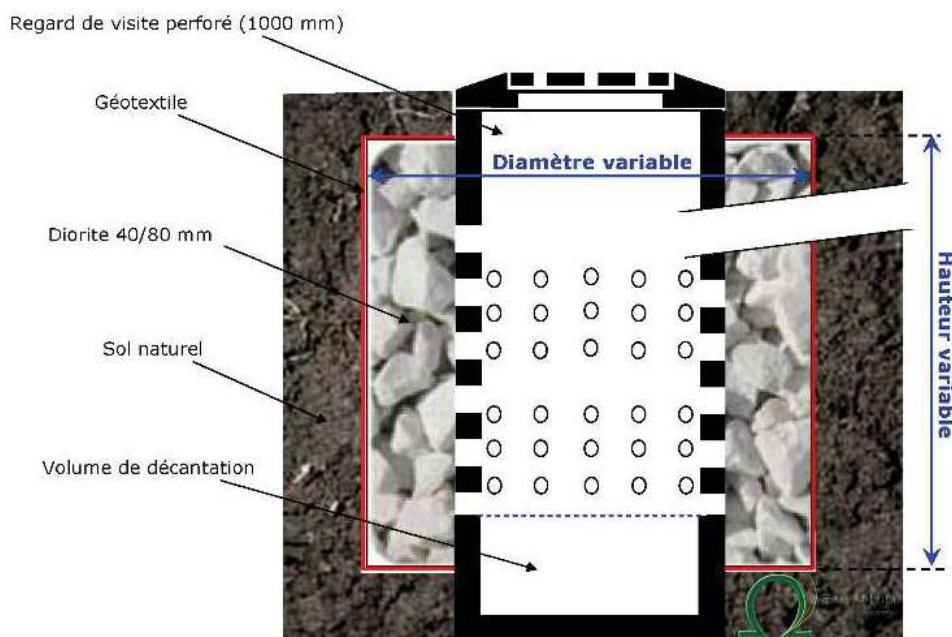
coupe de principe d'un puits d'infiltration avec décanteur
